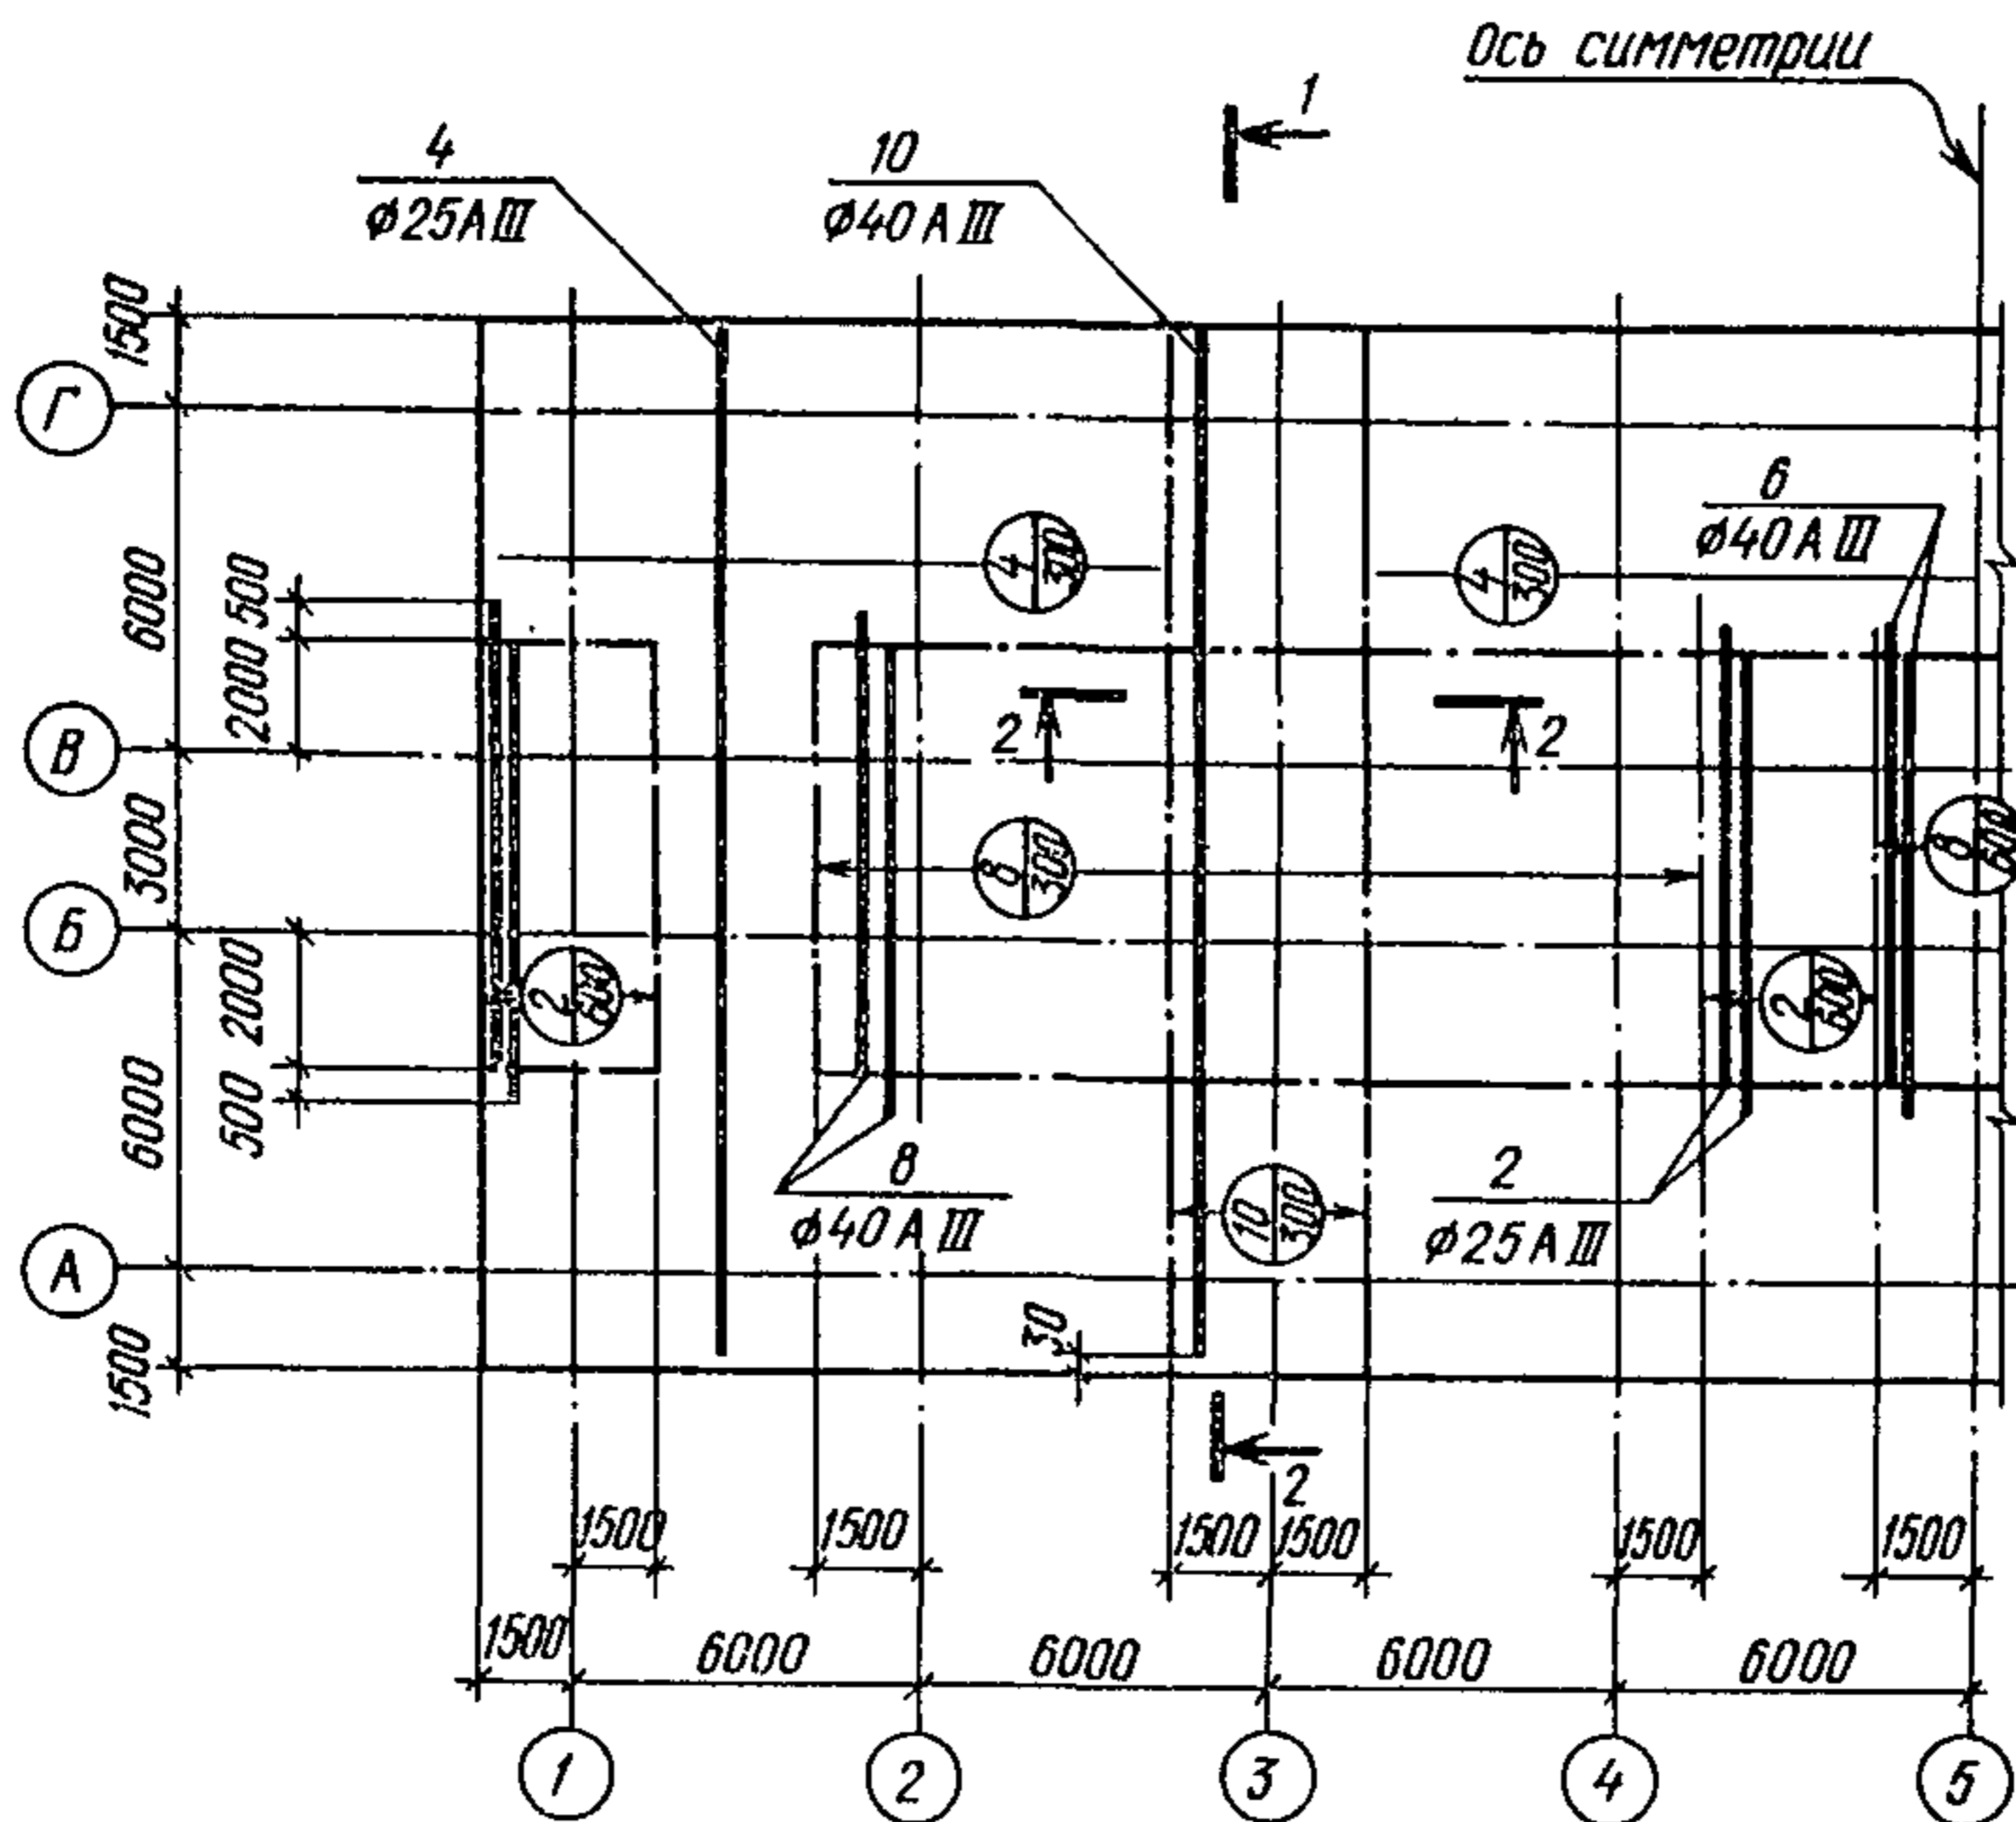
План раскладки арматуры первого слоя нижней зоны
